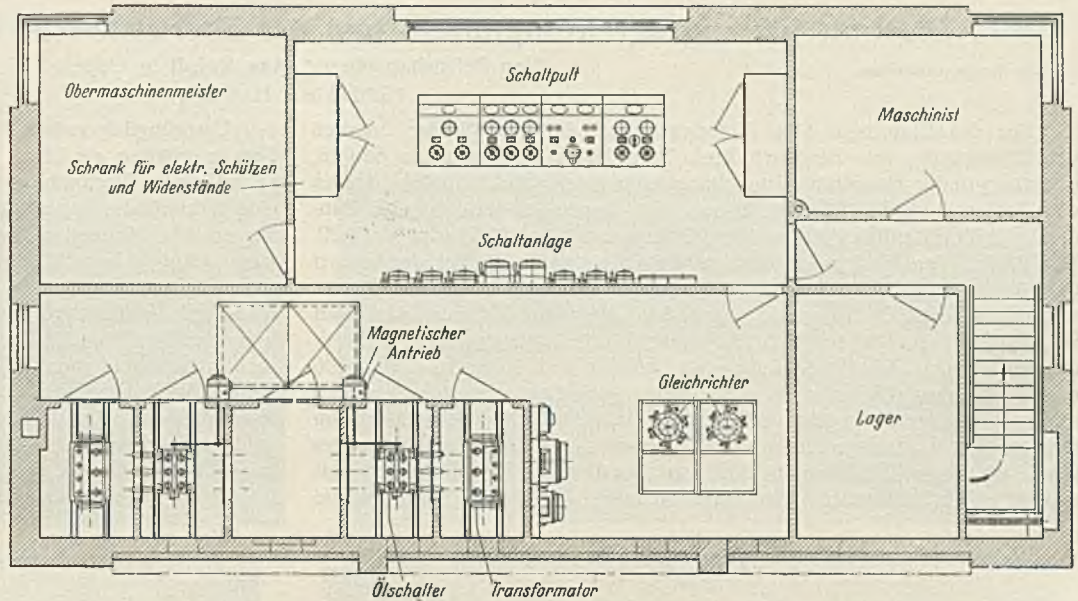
Gleichrichter- und Schaltanlage im Maschinenhaus Binnenhaupt.
